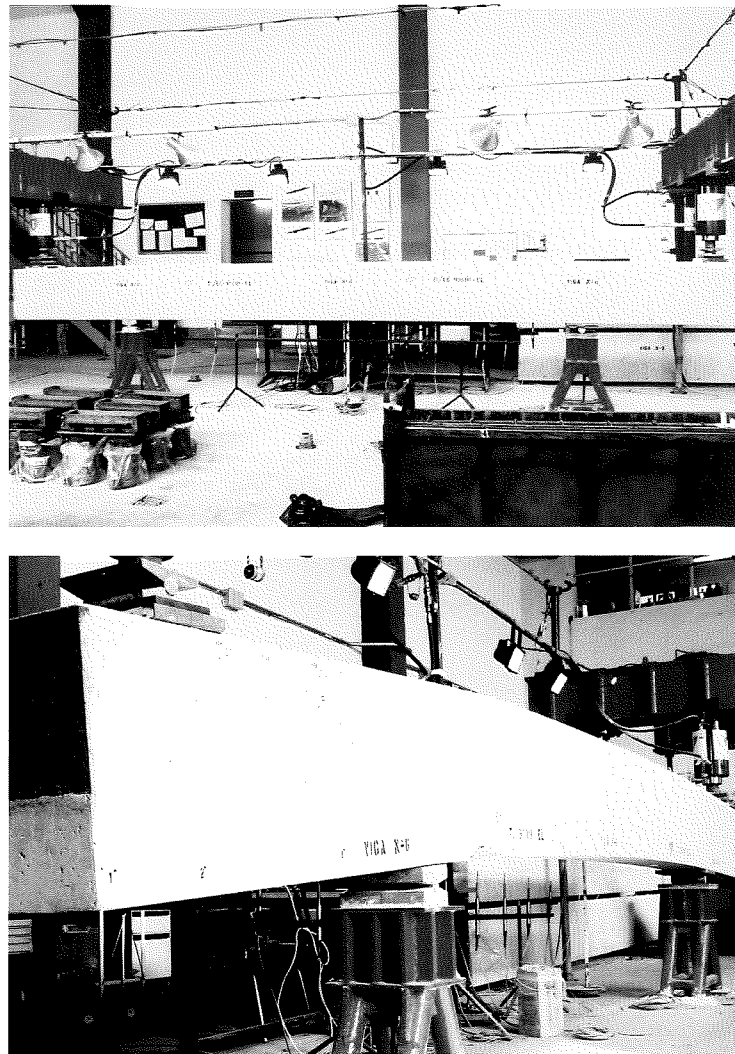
Vistas de dos de las vigas ensayadas. Laboratorio Central de INTEMAC
